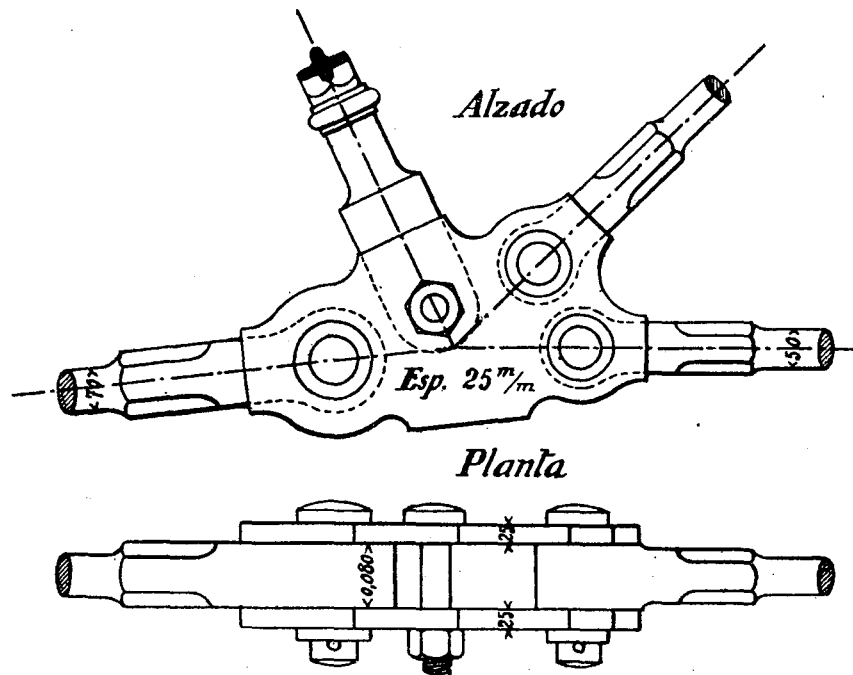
a 1066.—Detalles de un estribo en dos piezas.
